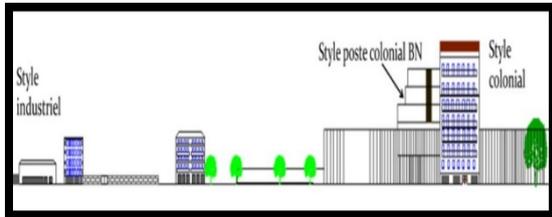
Façade sur le boulevard Med Belouizded (nord)
